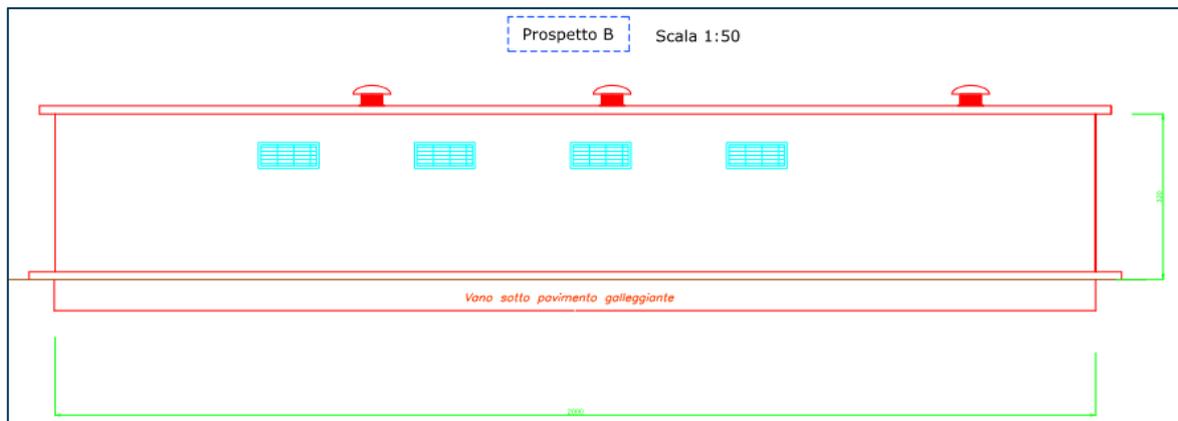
Prospetto lato strada della cabina di consegna dell'Area Nord di Impianto
